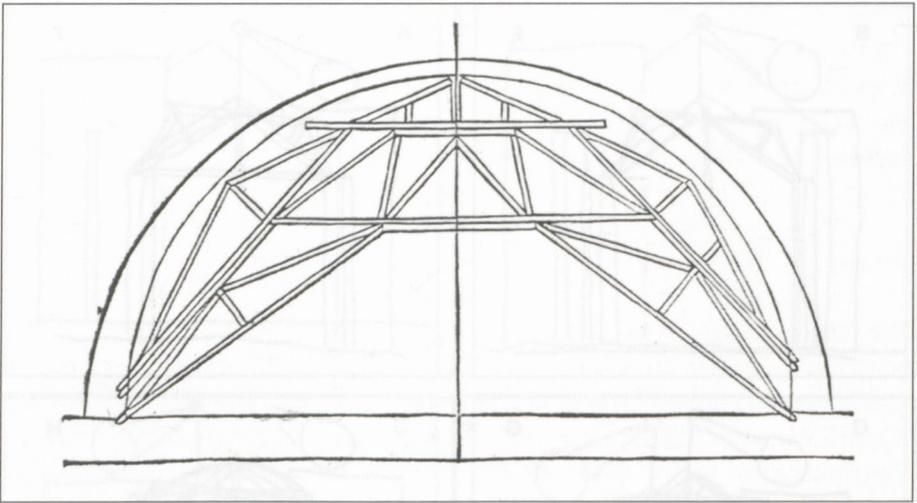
Schema zum Bau eines Lehrgerüsts [aus: Leonhard Christoph Sturm, Vollständige Anweisung alle Kirchen wohl anzugeben, Augsburg 1718, S. 16.].
